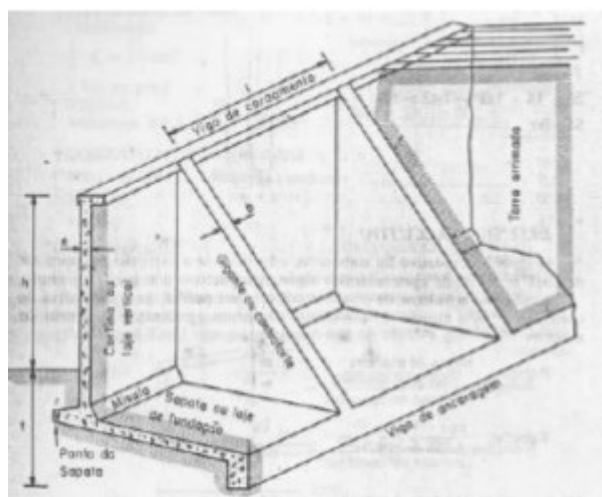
Muro em flexão com contrafortes, base externa ao maciço.
